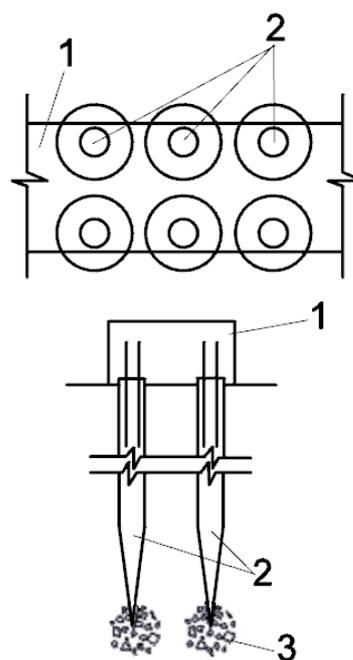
Конструктивная схема монолитного ленточного фундамента из НРС: 1 – фундамент (лента); 2 – набивные сваи; 3 – уплотненный щебнем забой скважины
